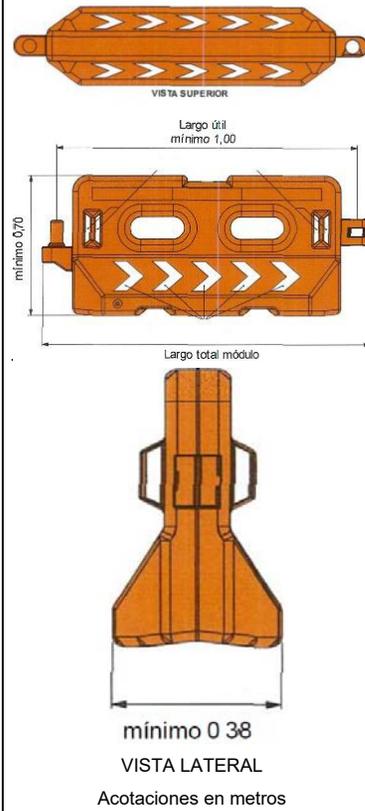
Barreras canalizadoras Tipo 2.
